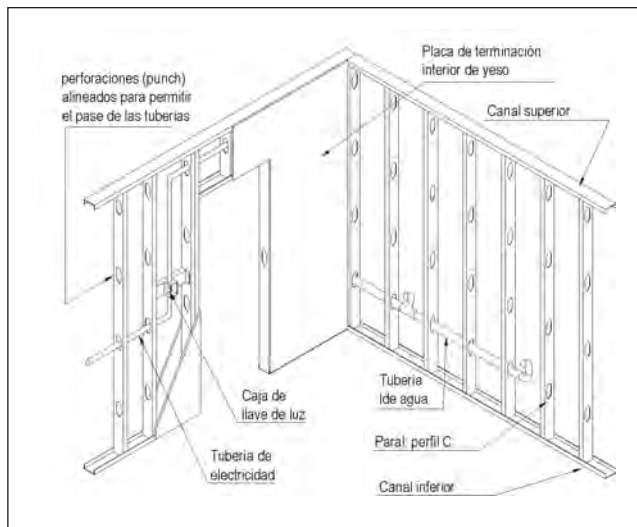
Panel de muros exteriores sin arriostramiento y con instalaciones interiores.
